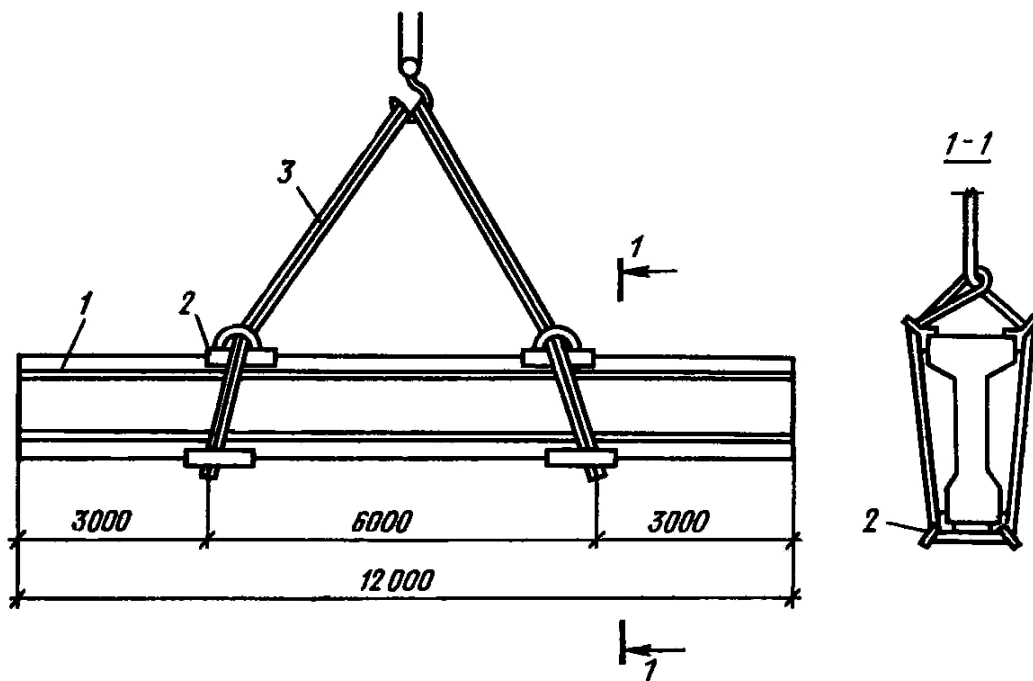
Строповка підкранових балок універсальними стропами:
